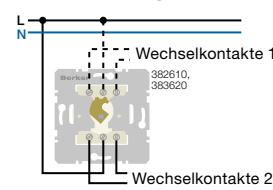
Wechselschalter 1- und 2-polig für Schließzylinder [Best.-Nr. 3826 10, 3836 20]
